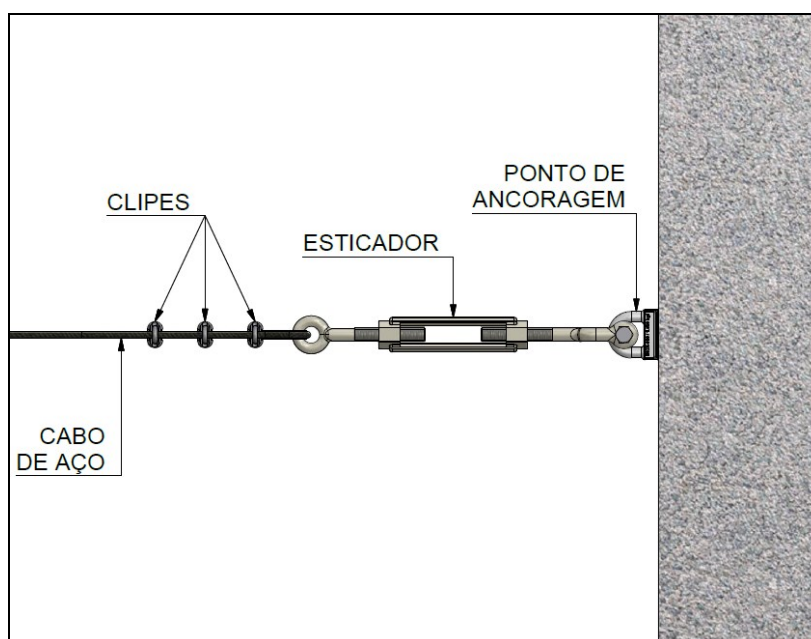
Detalhe Montagem Terminal do Cabo de Aço
